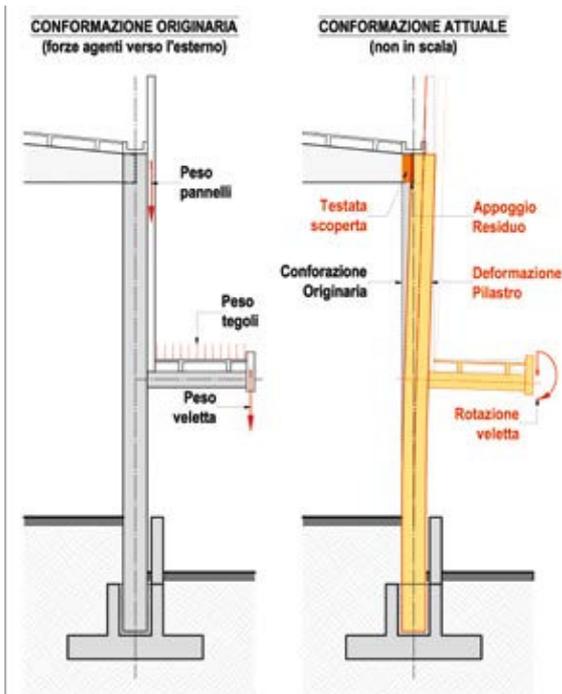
Deformazione pilastro: interpretazione qualitativa del fenomeno di flessione del pilastro, poi confermata numericamente.
